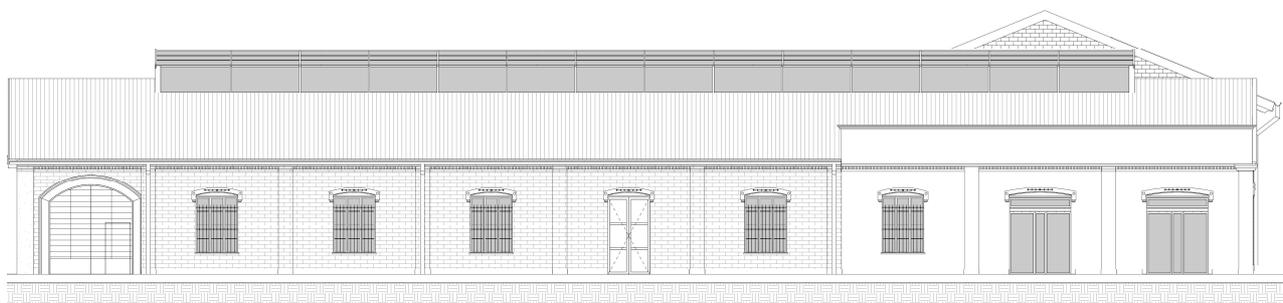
Prospetto Sud Fab-lab (Tav. n°8 scala 1:100)
